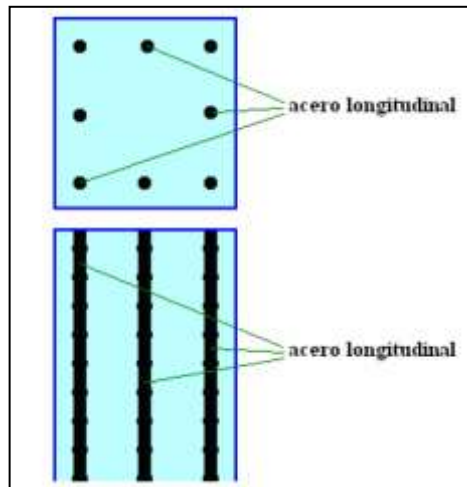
Columna de concreto reforzada con acero; Fuente: (Proaño, 2011)
